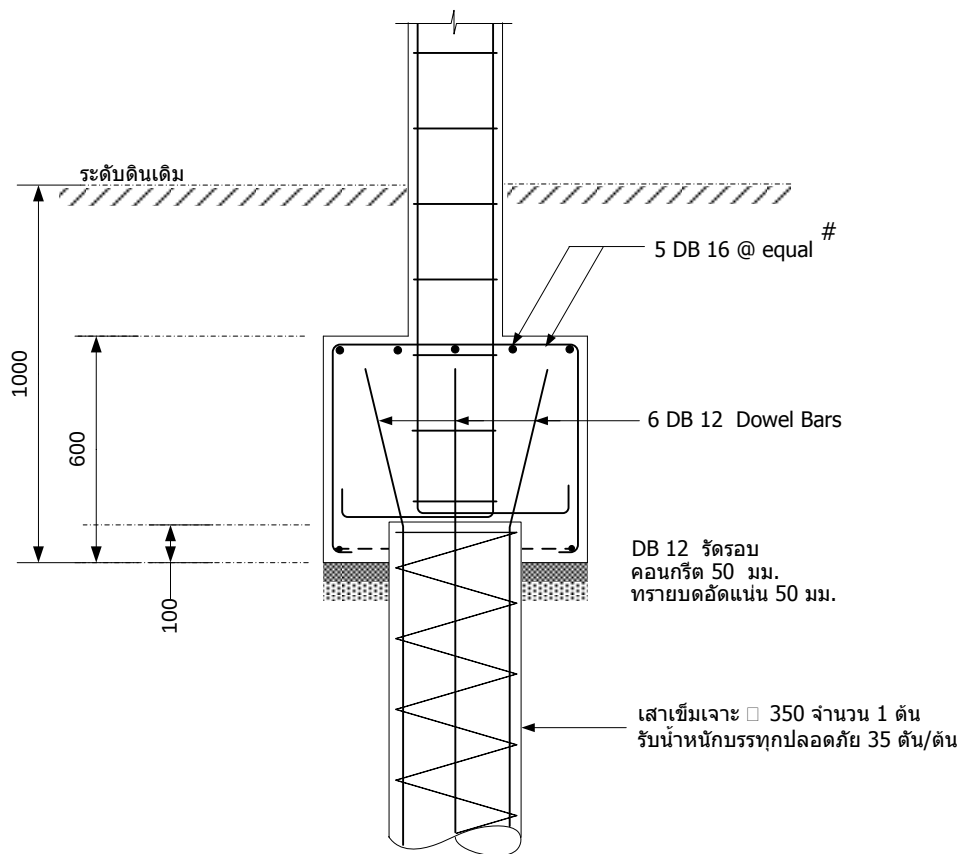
รูปแบบการจัดวางเสาเข็ม
